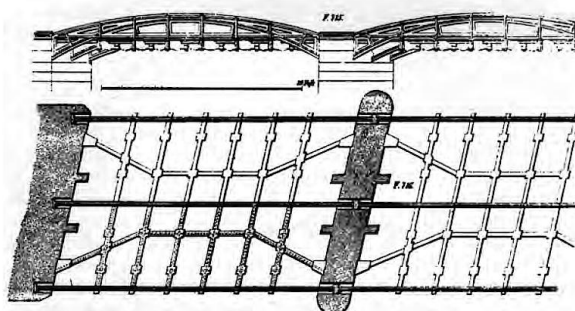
Eisenbahnbrücke über die Elz bei Hecklingen — Ansicht und Grundriß —
